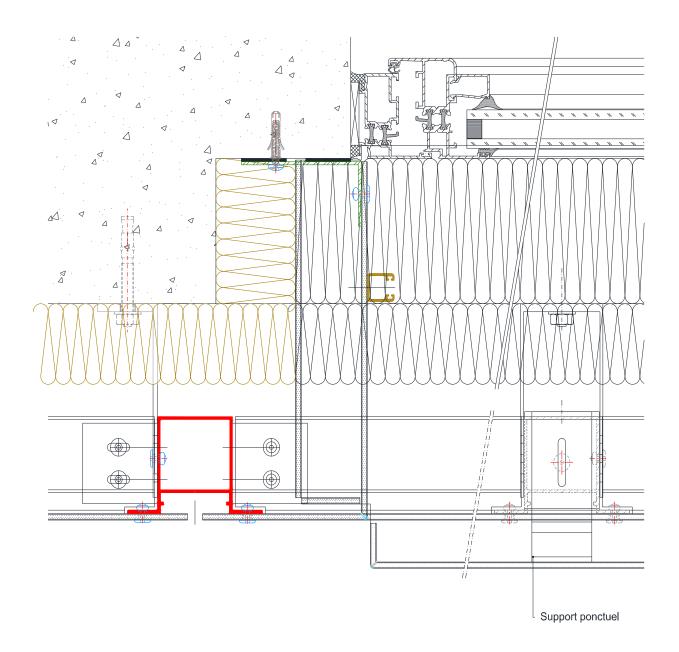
Tableau de baie – Coupe horizontale- Système riveté RV 60 4c
